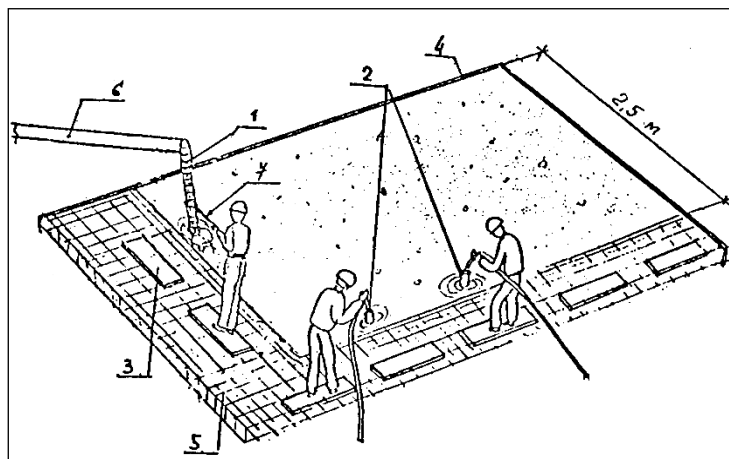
Схема організації робочого місця при бетонуванні
